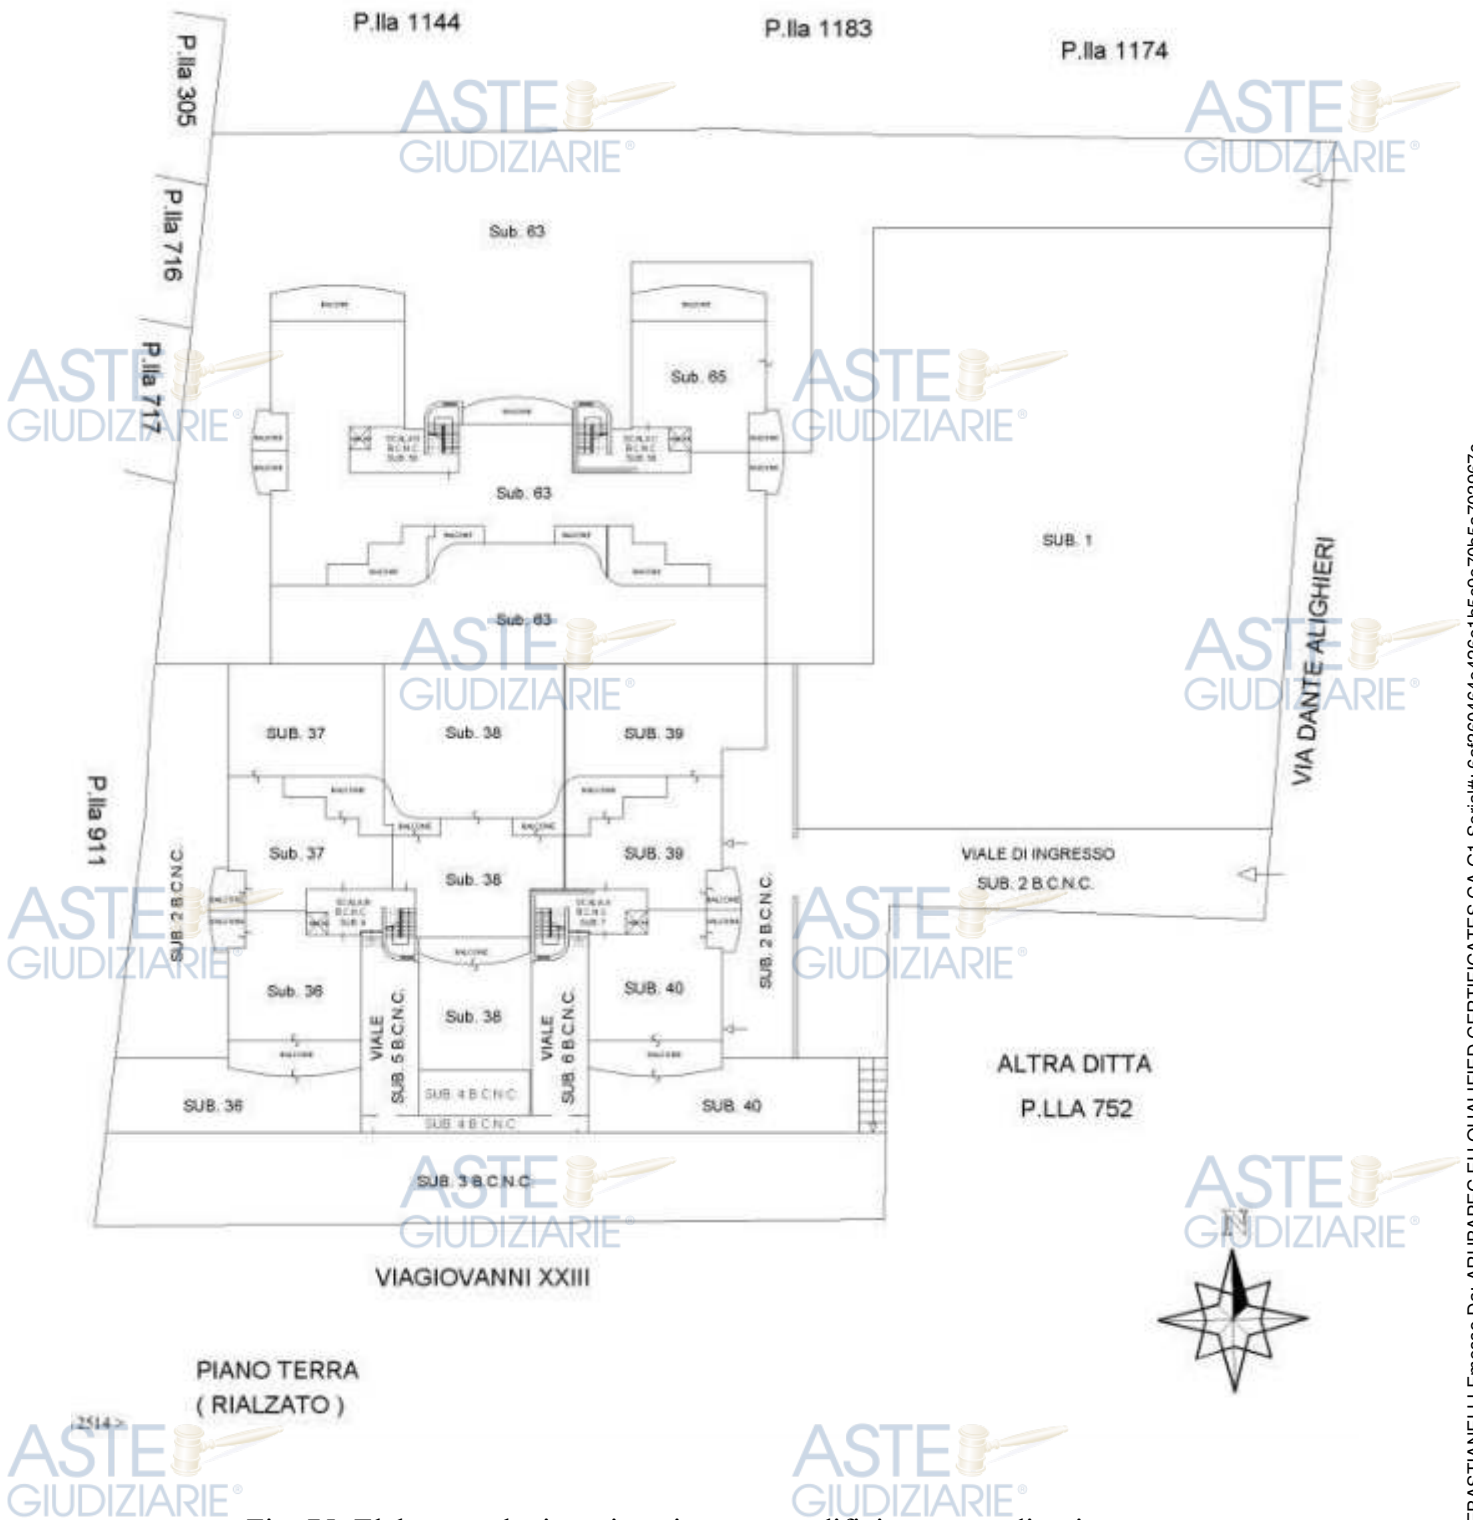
Elaborato planimetrico piano terra edificio compendio pignorato
